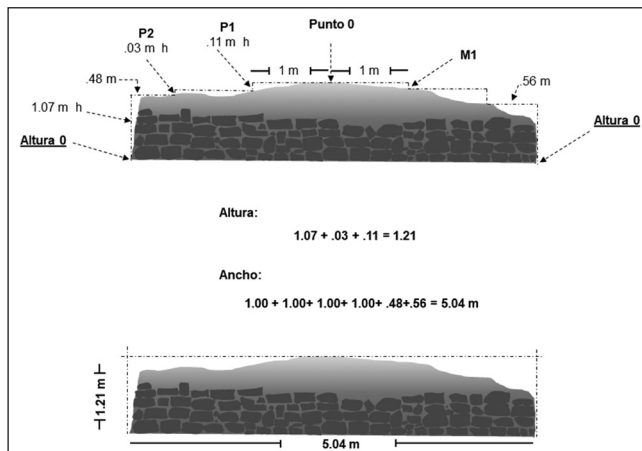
Distancias a medir sobre la Estructura 2. Vista en planta
